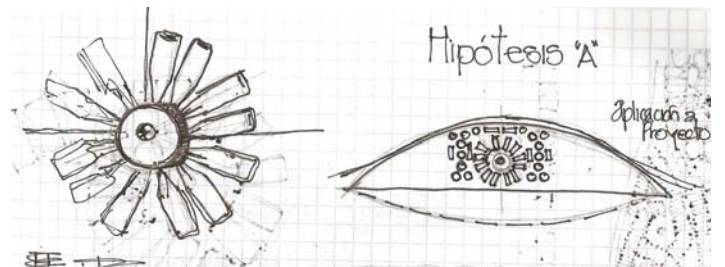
Croquis del armado utilizado en la Iglesia del Pinole, para colocar botellas de vidrio en la fachada.
